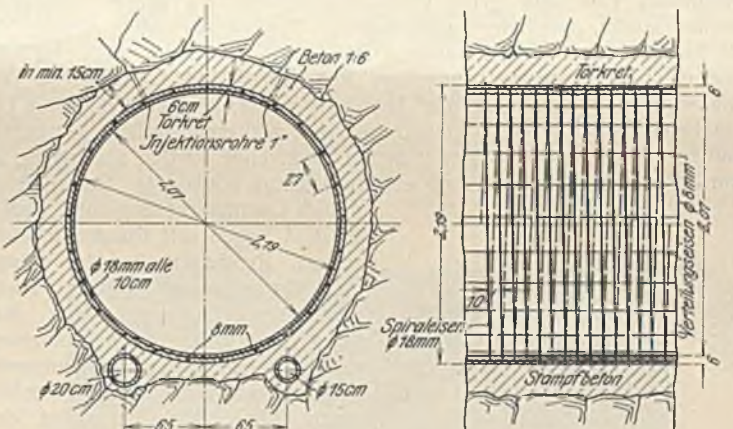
Normalprofil der auf 4 at bewehrten Stollenstrecken.
